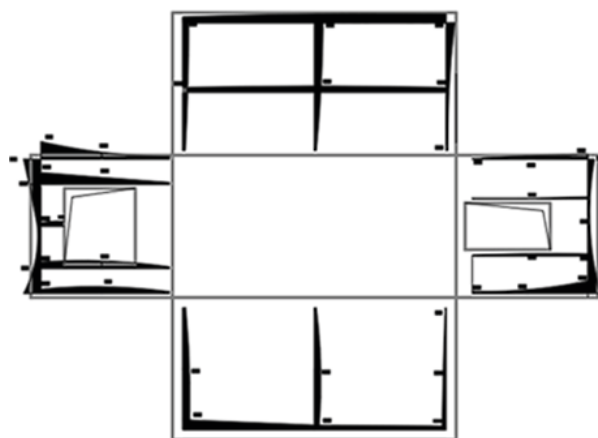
Горизонтальные перемещения стен при разрушающей нагрузке
